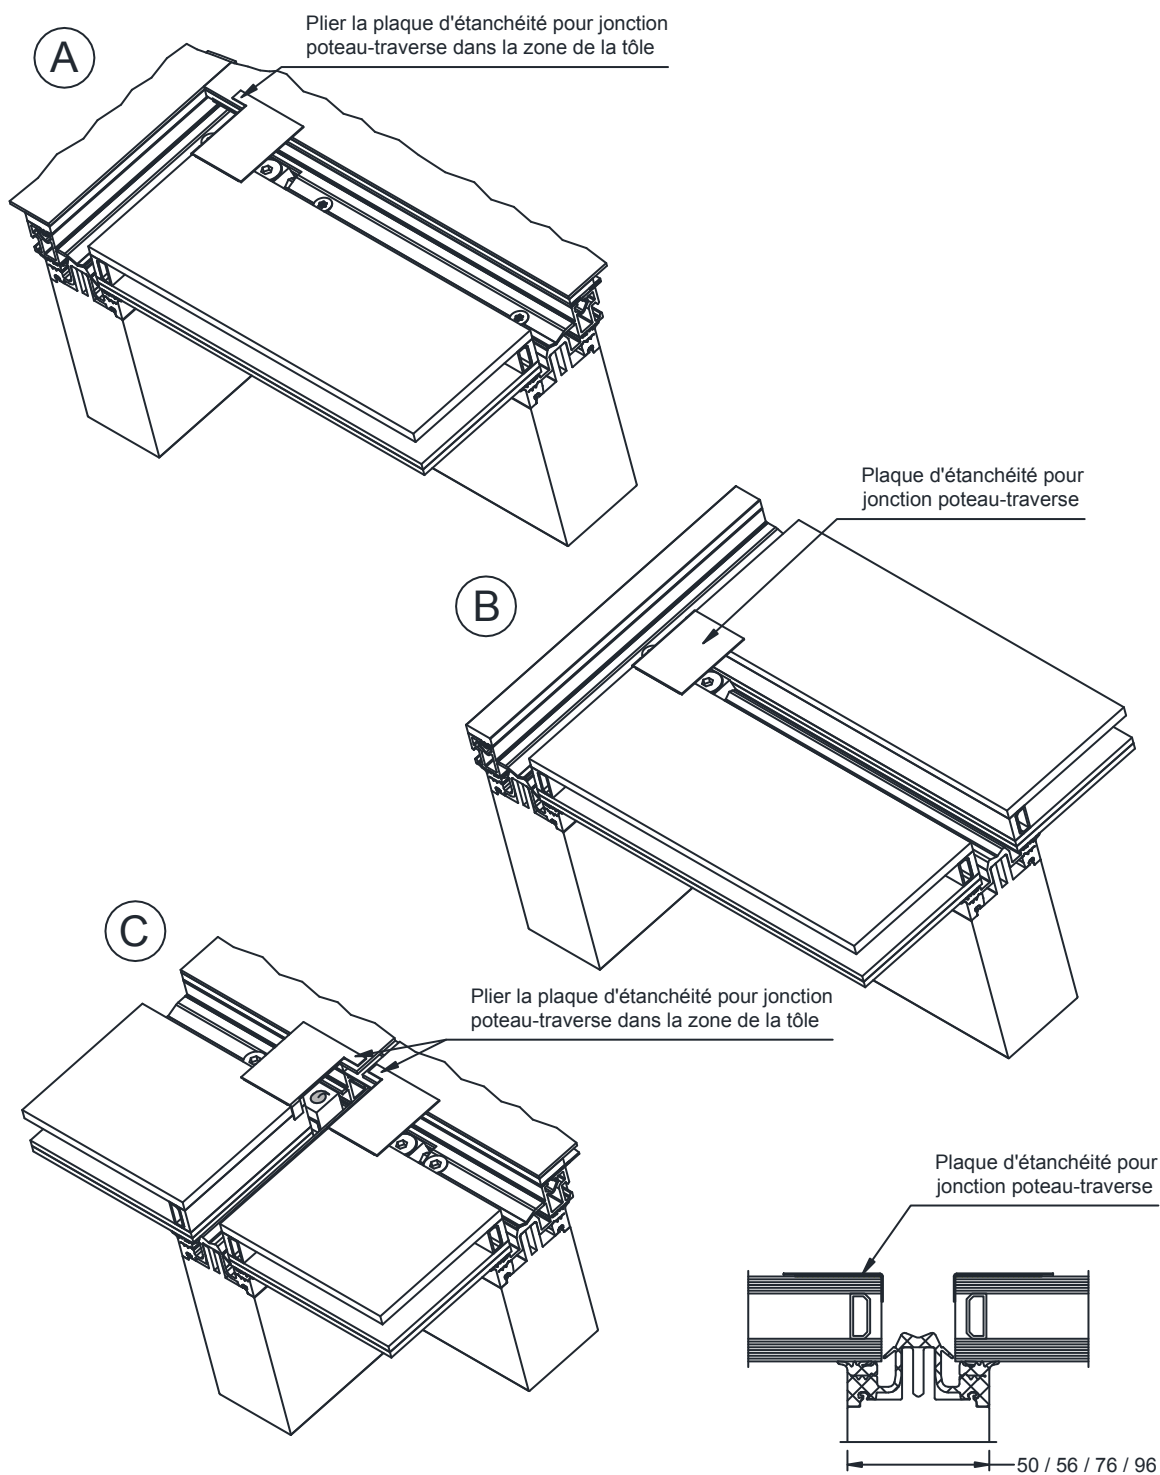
Montage des plaques d'étanchéité pour jonction poteau/traverse à 90°
